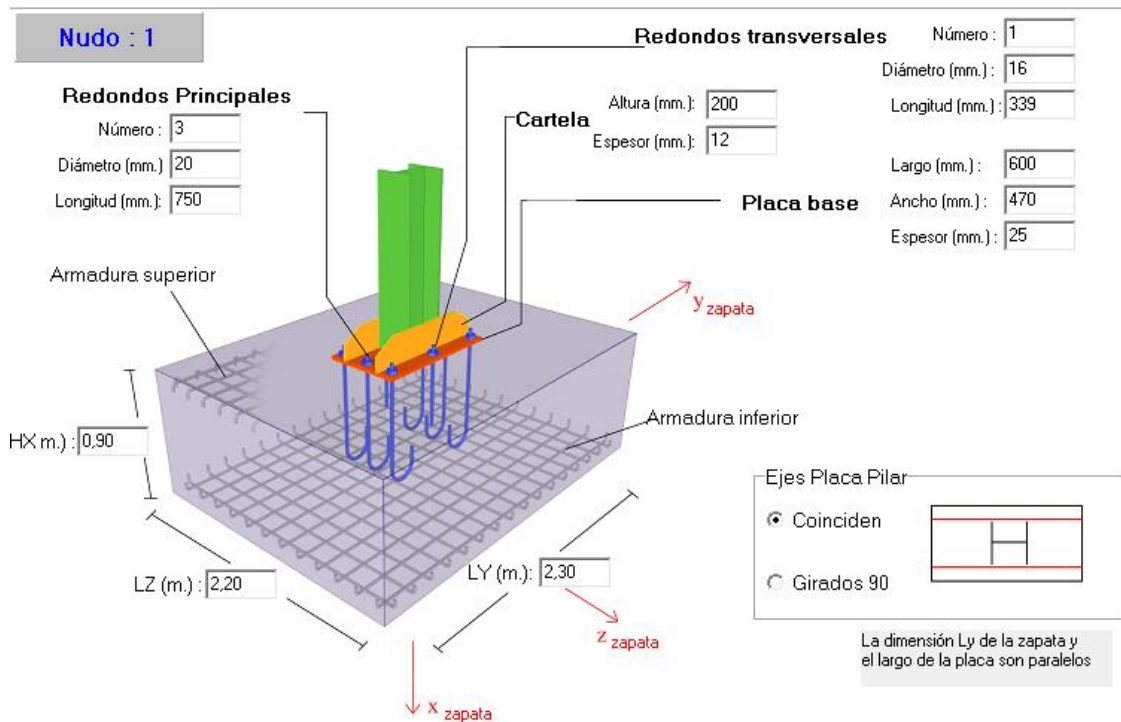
Detalle zapata tipo 1 (Nudo 1). Fuente: Metalpla XE 64
